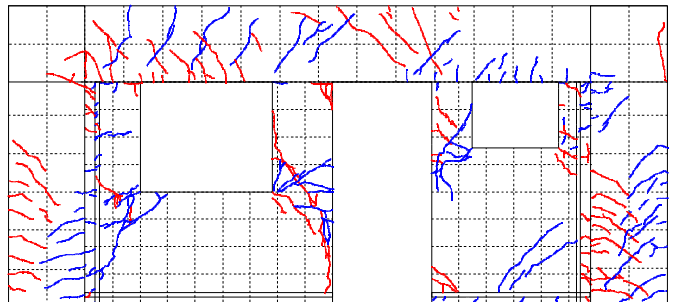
ひび割れ損傷(スリット付き試験体, R=1/120rad.)
